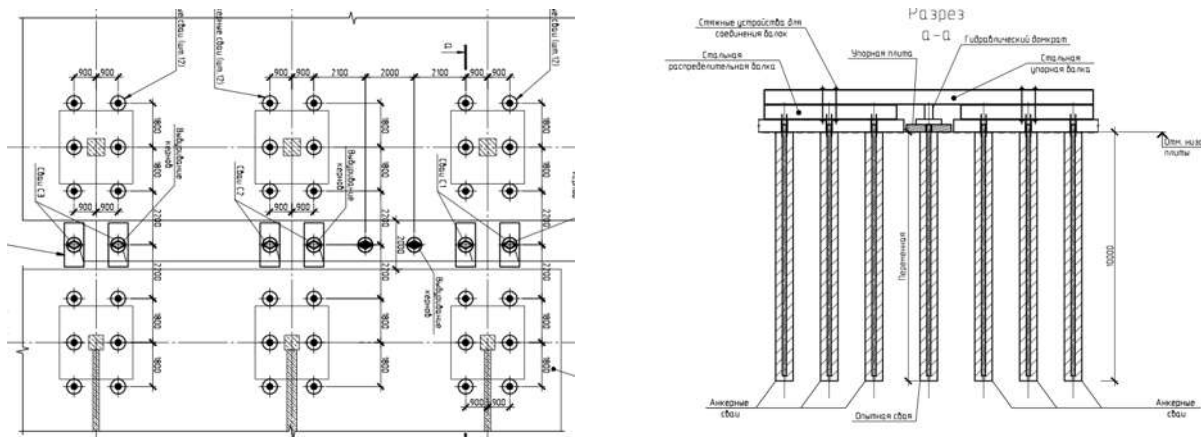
Схема проведения испытаний вдавливающей нагрузкой
